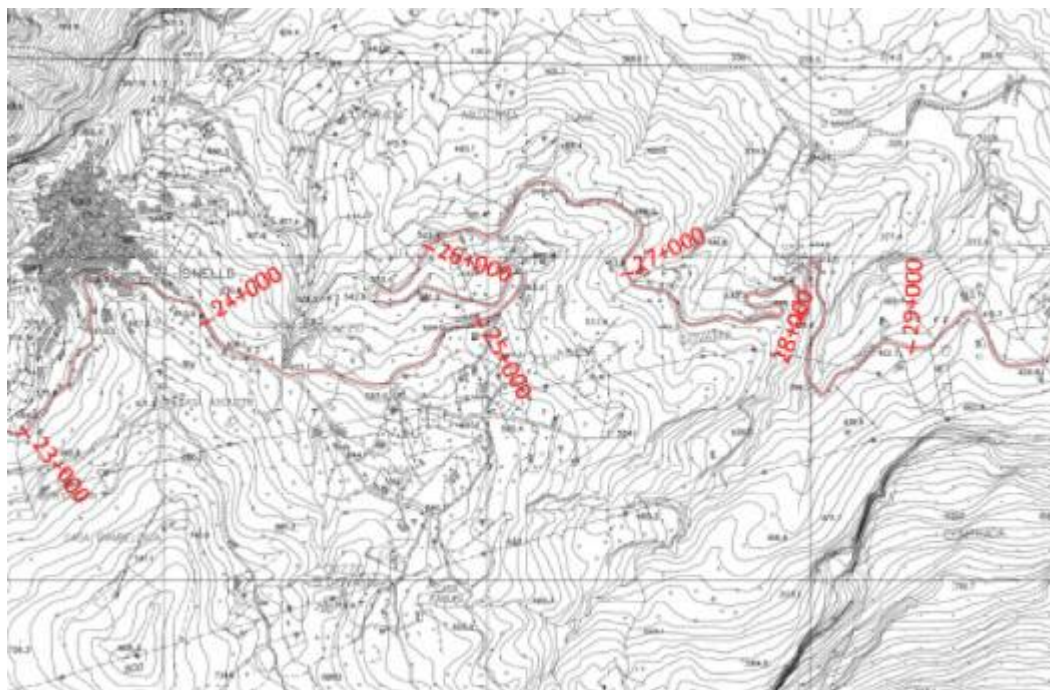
Stralcio planimetrico S.P.9 km 27+100.
